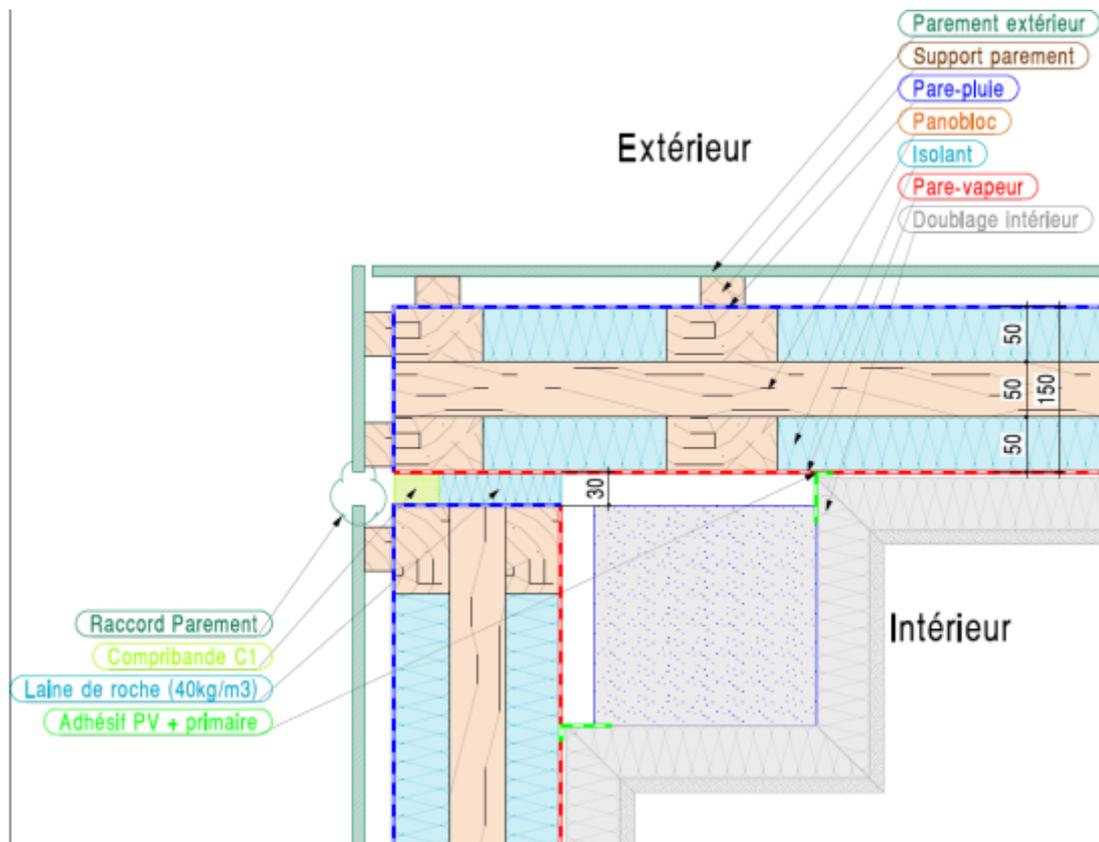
Liaison avec poteau d'angle en béton / coupe horizontale
